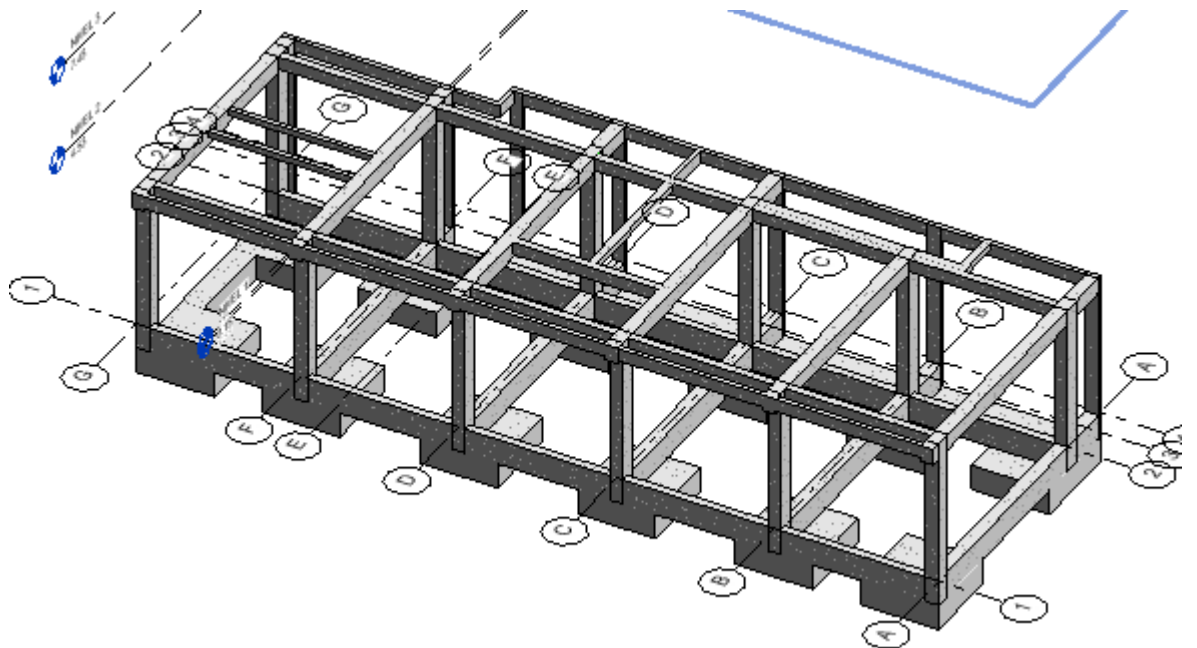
Vista 3D del modelado de vigas (Fuente: Elaboración Propia).
